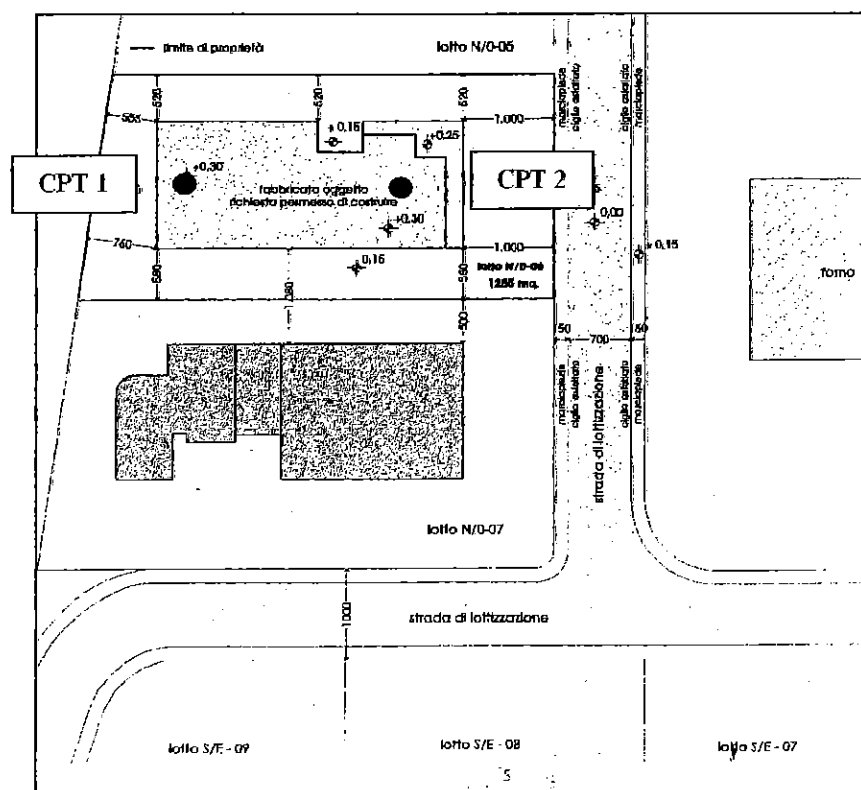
Planimetria di progetto e ubicazione prove penetrometriche
